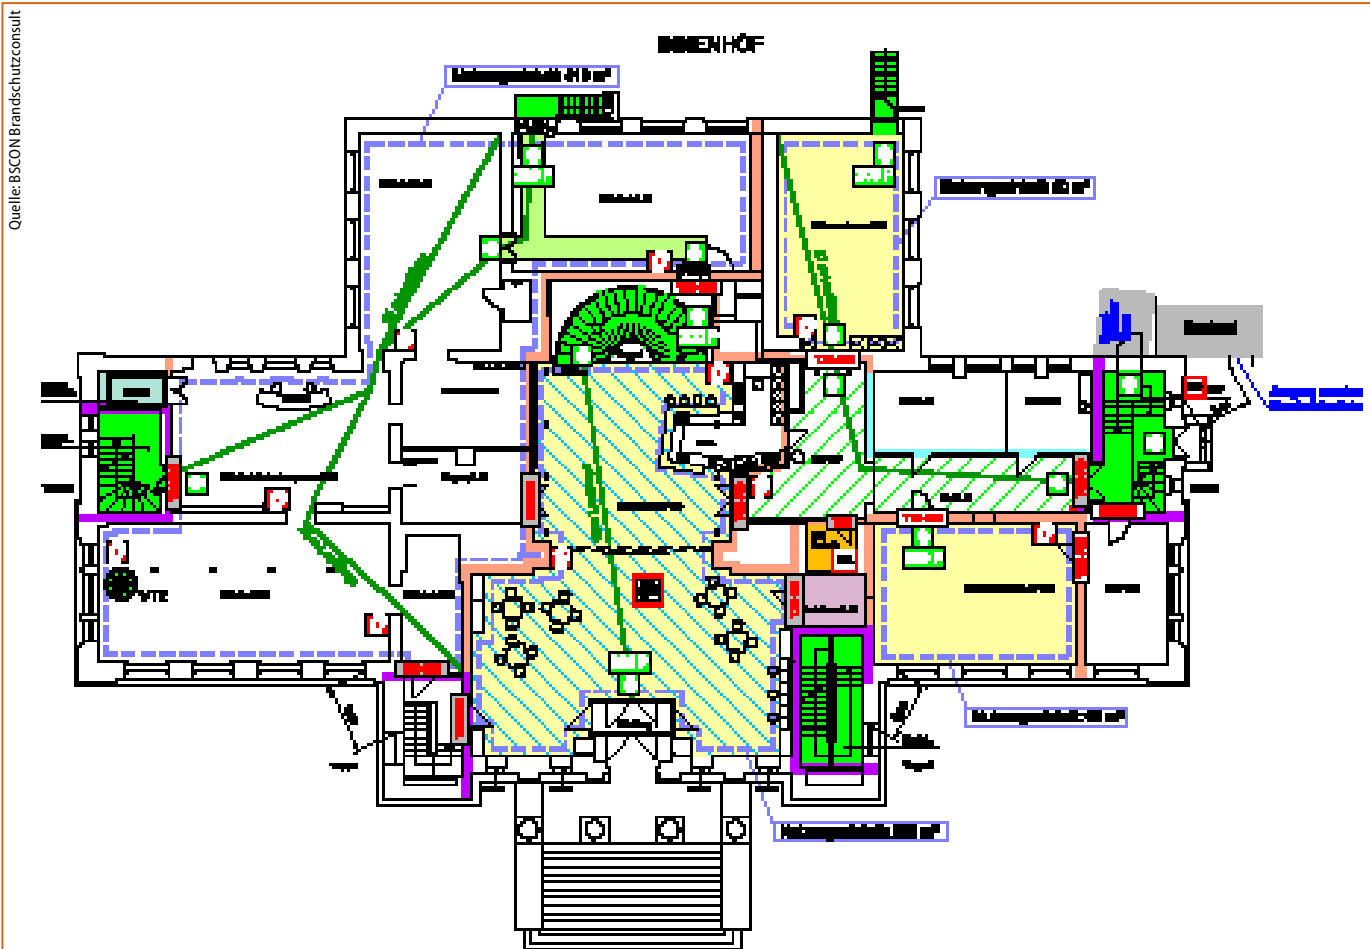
Grundrissplan des Erdgeschosses. Insgesamt verteilen sich die Nutzungsbereiche des Gebäudes auf fünf Geschosse.
